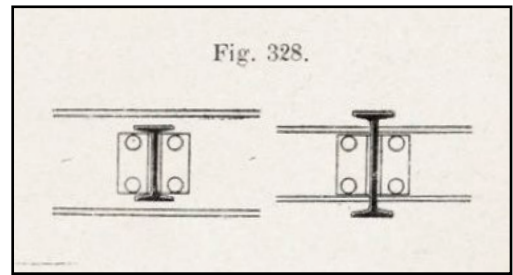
Plan d'un assemblage par cornière rivetée, par Deschamps Henri, 1908.
